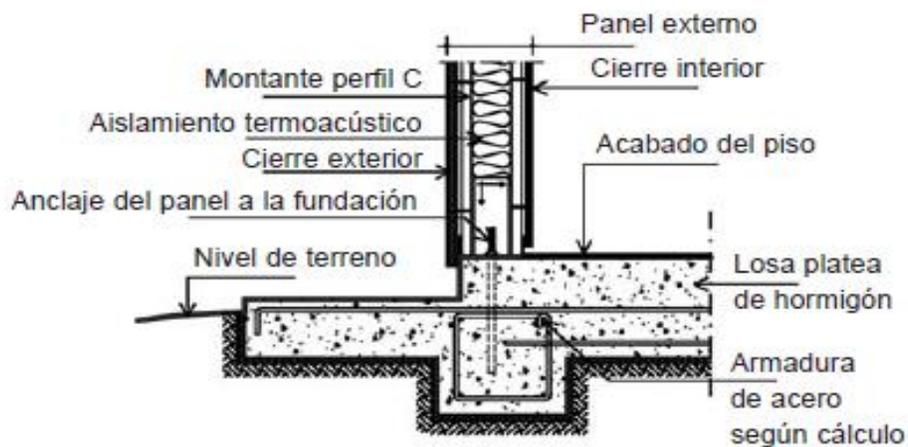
Detalle esquemático de anclaje del panel estructural a una losa de hormigón.
